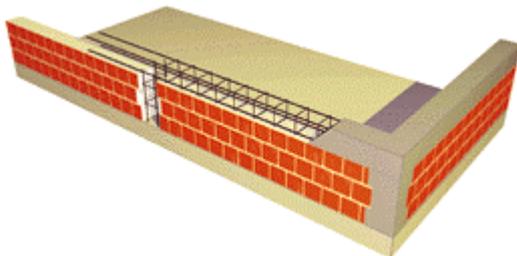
Irrigidimenti in c.a. , opportunamente ammorsati, in un parapetto in elementi forati di laterizio.
